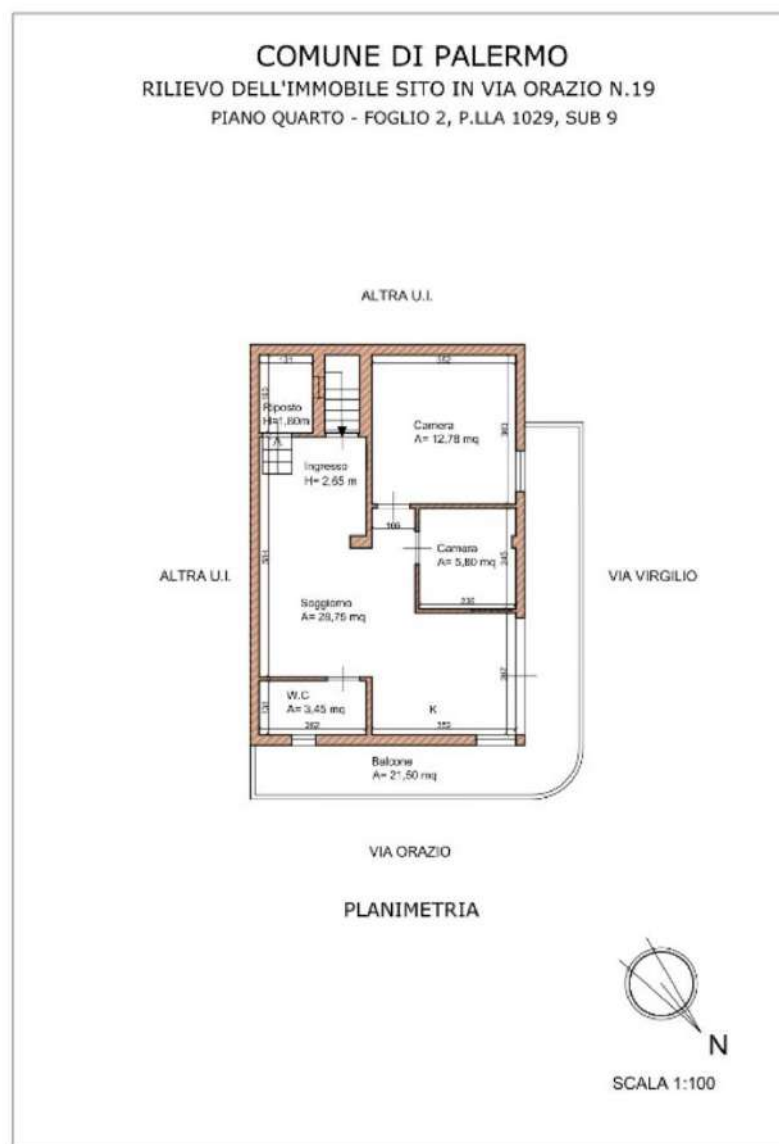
Rilievo planimetrico del lotto pignorato alla data del sopralluogo
